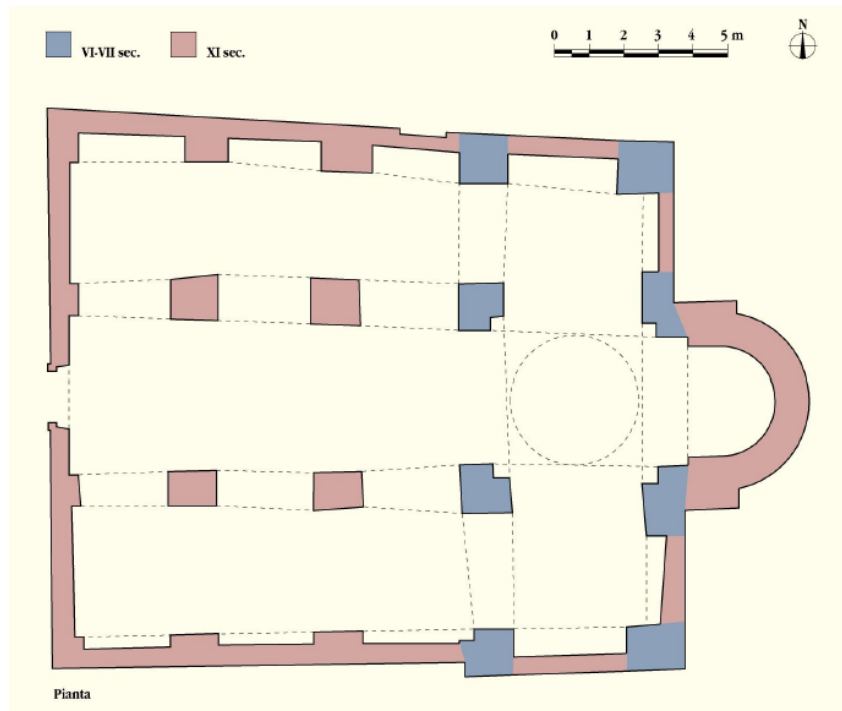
Cabras: Grundriss der Kirche San Giovanni in Sinis
